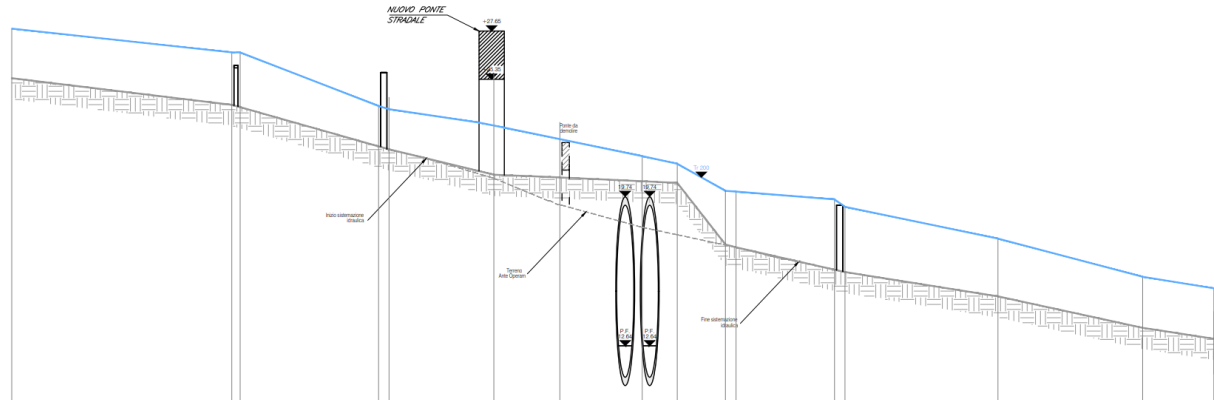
Stralcio del profilo del Rio Casazza, dove si mostra l'innalzamento del fondo dell'alveo sopra la galleria Castellari.
